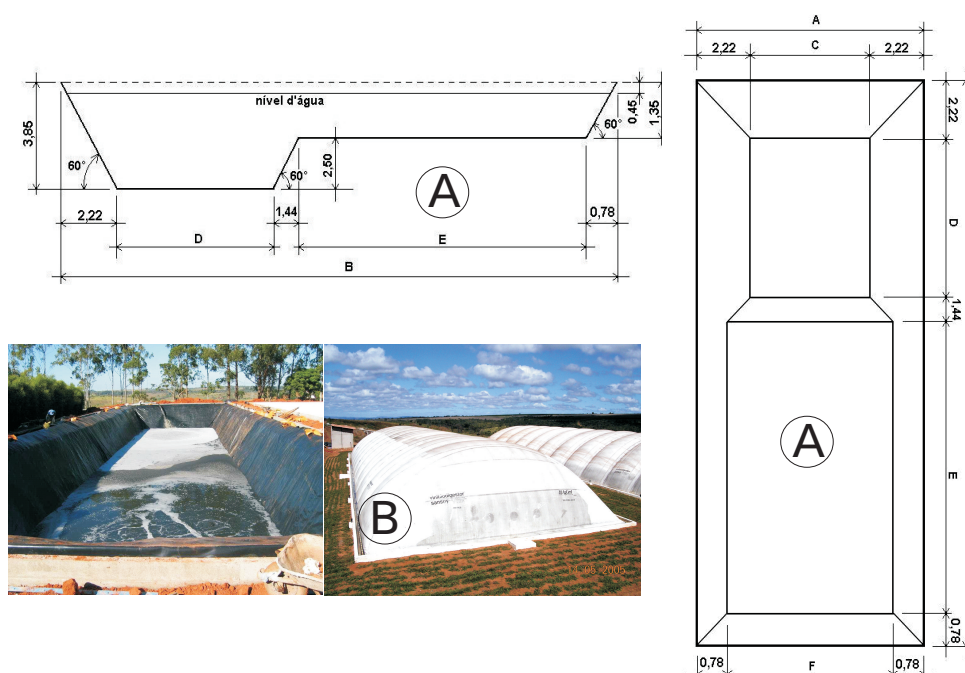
Modelo de biodigestor adotado pela empresa AgCert, em planta baixa (A) e construído (B).
